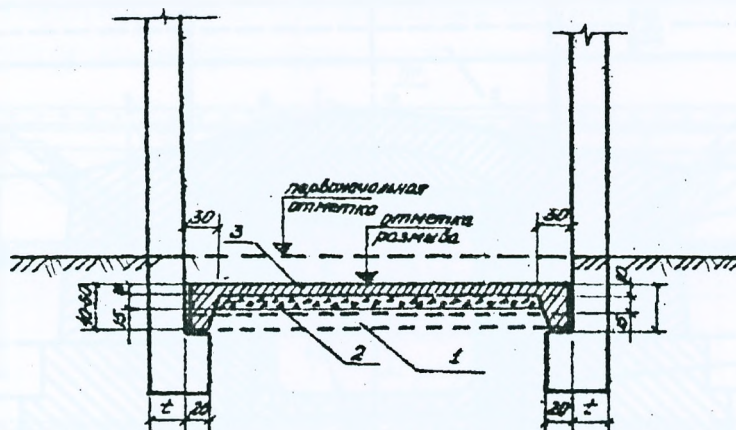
Конструкция укрепления дна русла: 1 – распорки, подлежащие замене; 2 – щебеночное основание (15 см); 3 – монолитная бетонная плита.
